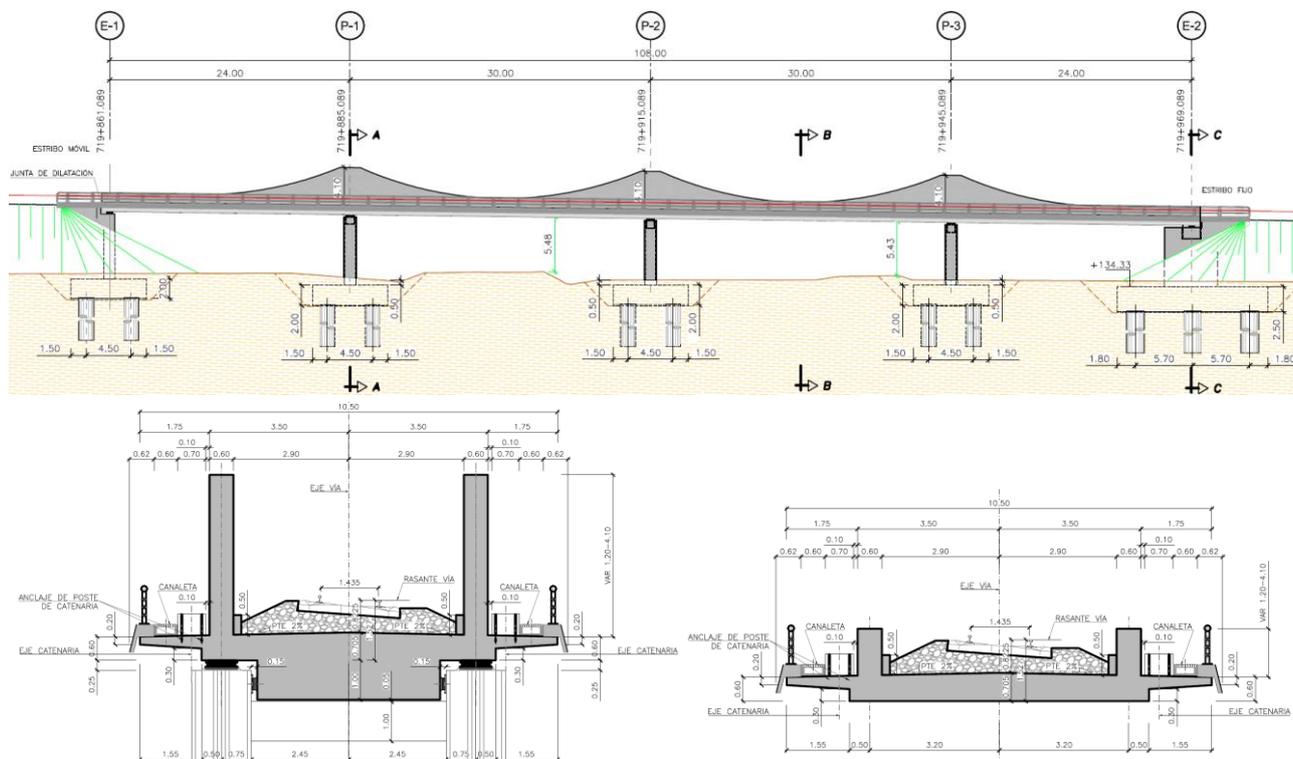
Viaducto sobre la carretera N-347. Alzado longitudinal y secciones tipo.
